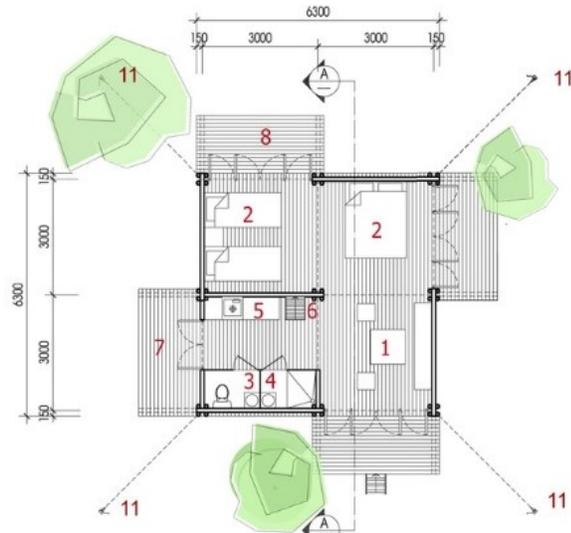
Distribución Planta, Fuente: (H&P Architects, 2013)
